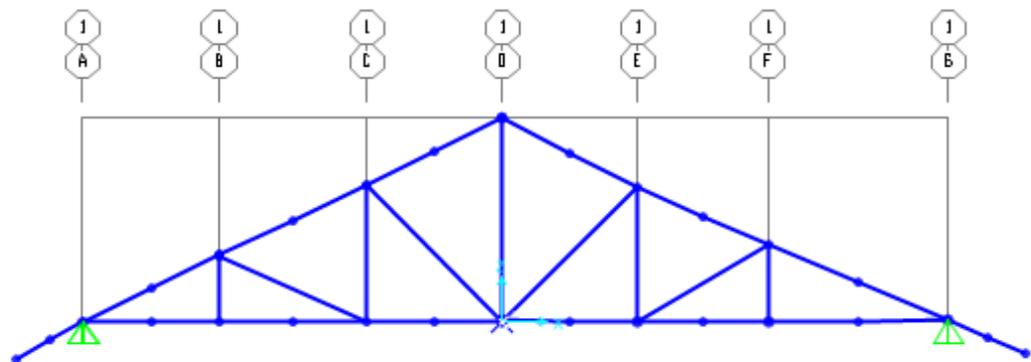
Plano de la Armadura Sap2000 V-19.2.0
